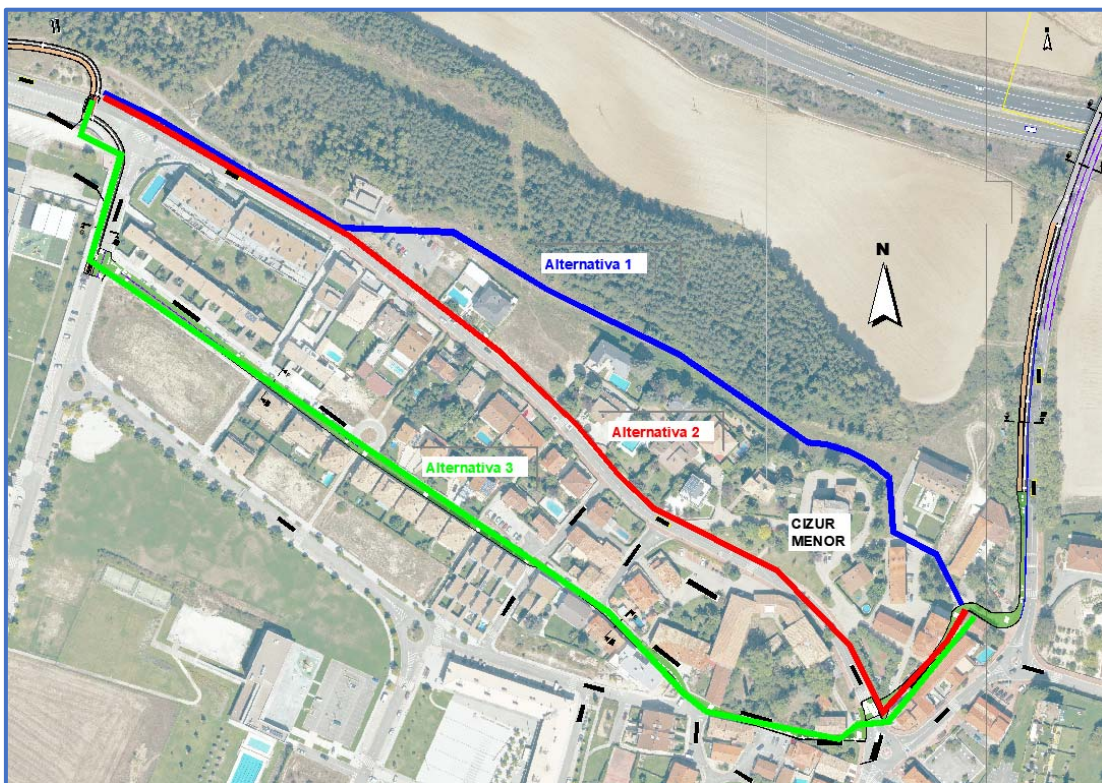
Planta de las tres alternativas de trazado analizadas para el tramo de Cizur Menor.
